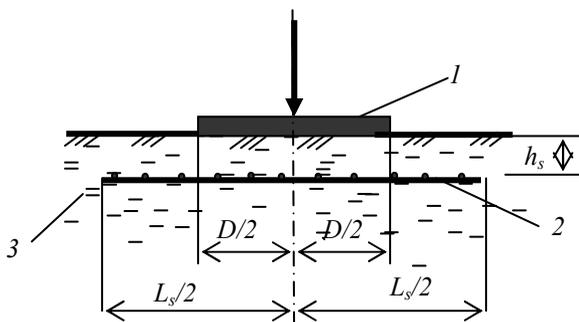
Схема установки модели фундамента и арматурной сетки:
